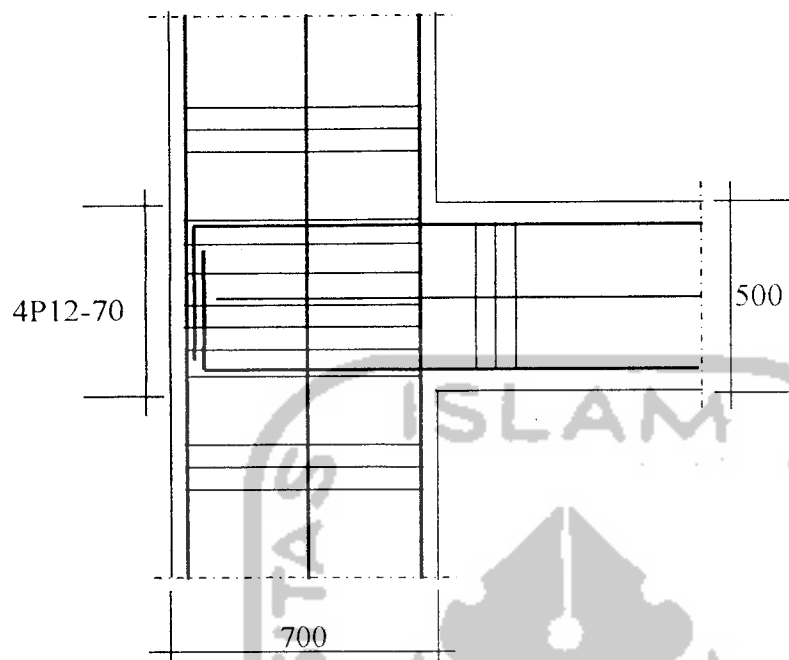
Detail Joint Balok-Kolom D Lantai 10 dan 11
